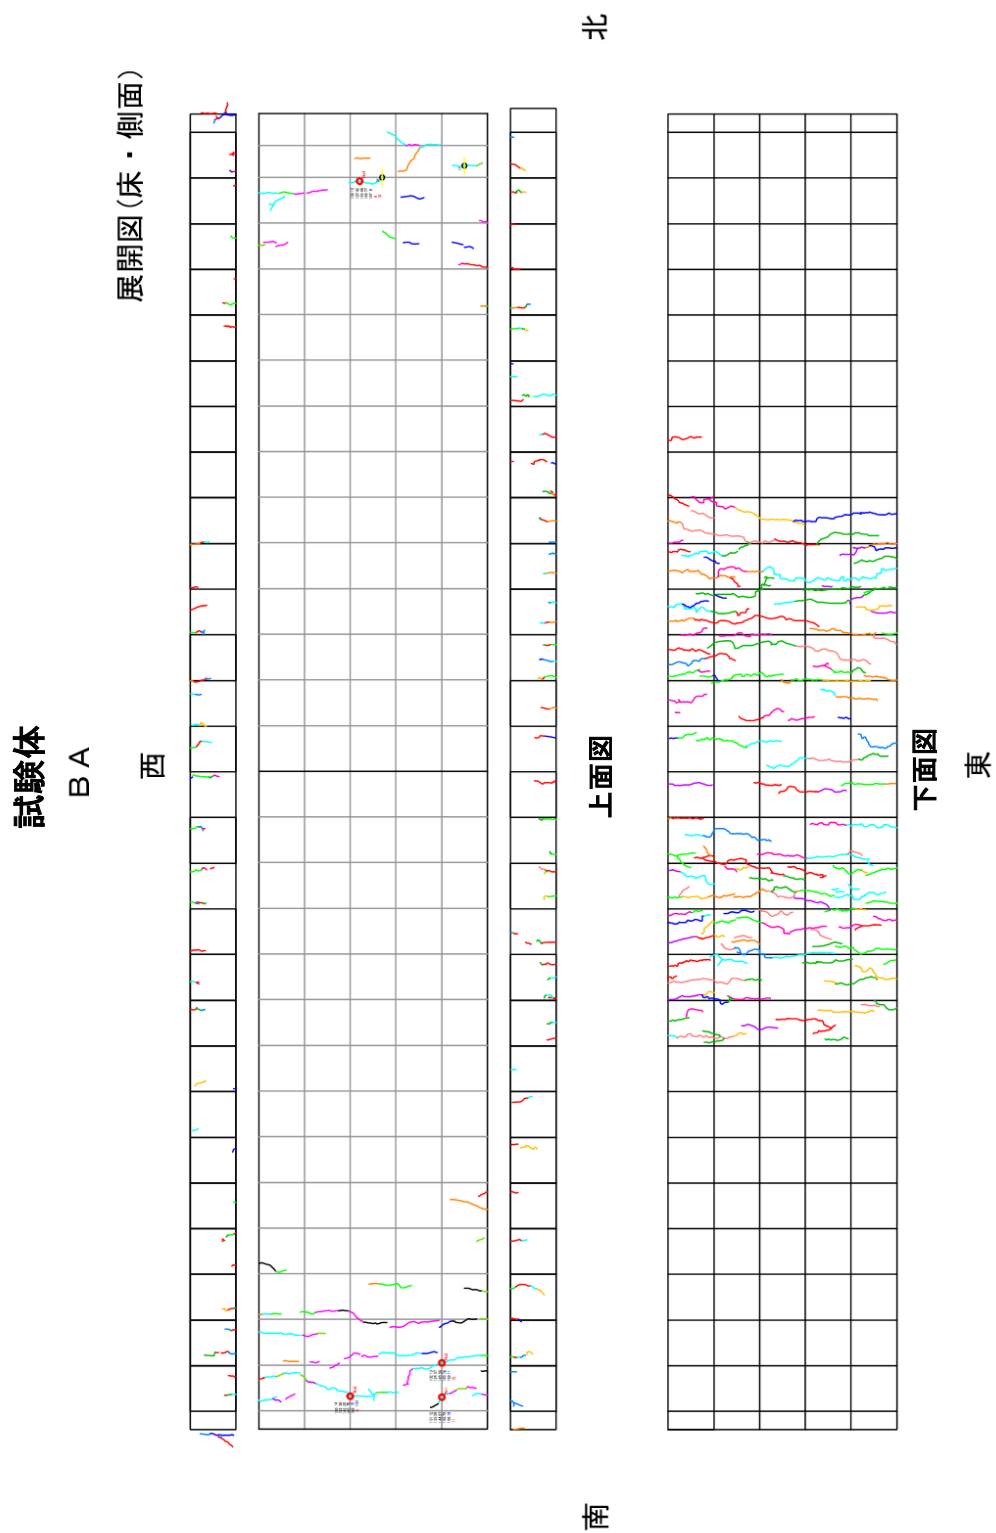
試験体 BA ひび割れ図
